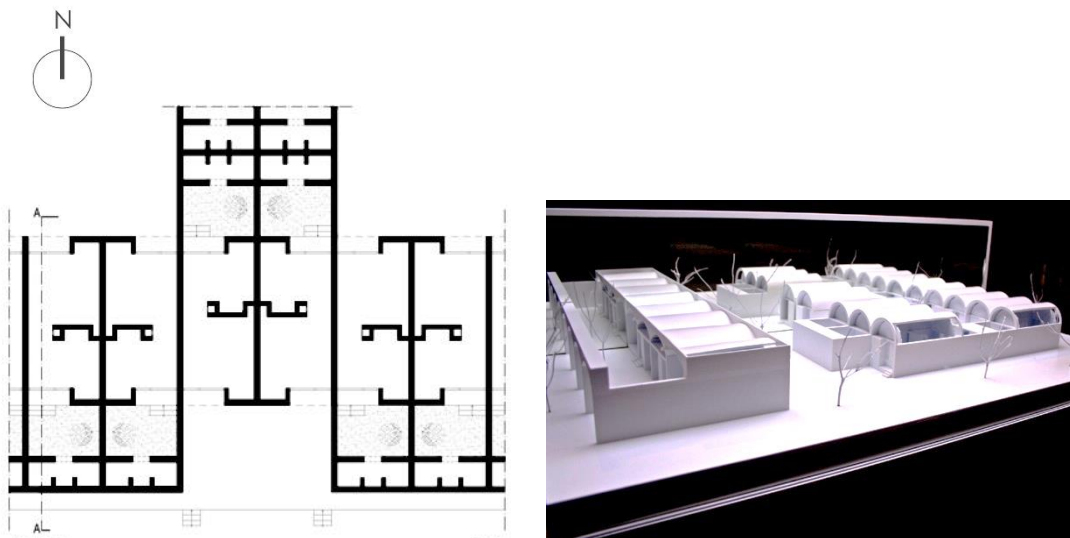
, 91: Viviendas para la ATIRA. Planta y vista de maqueta
